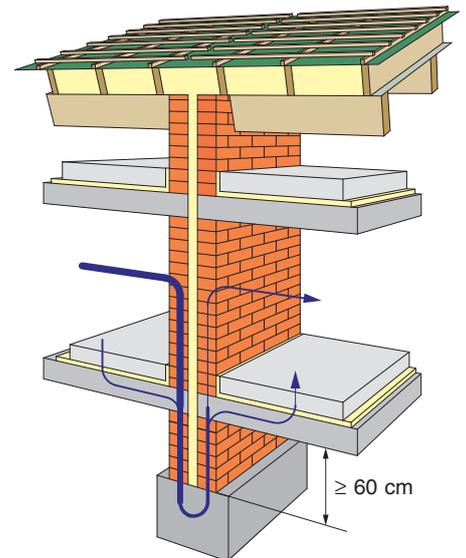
La transmission structurelle du bruit par les fondations communes est considérablement amortie par l'encastrement des dalles en béton dans les parois du mur creux.
